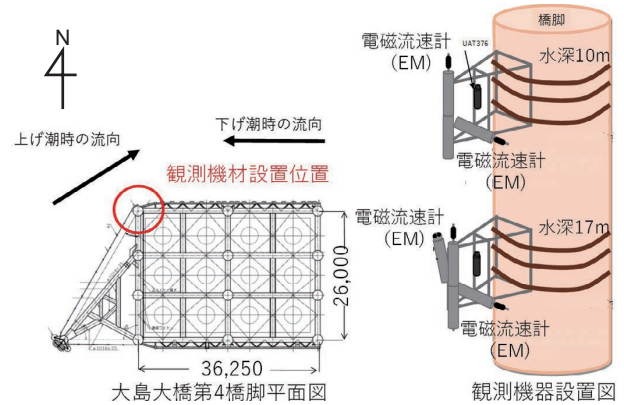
大島大橋第4 橋脚平面図と観測機器設置概要図
